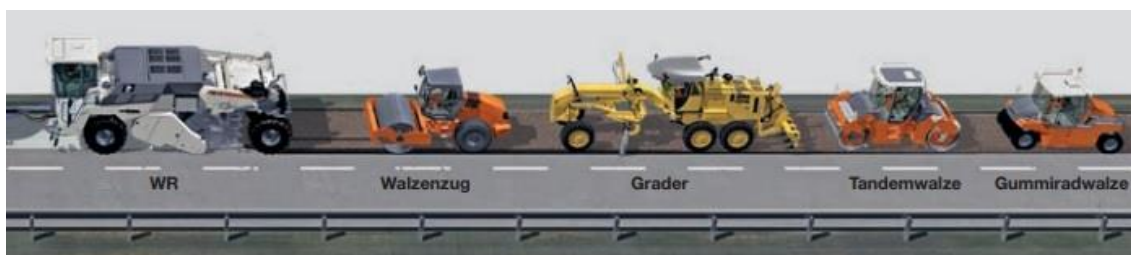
Varianta dávkování cementu před strojem [5]
